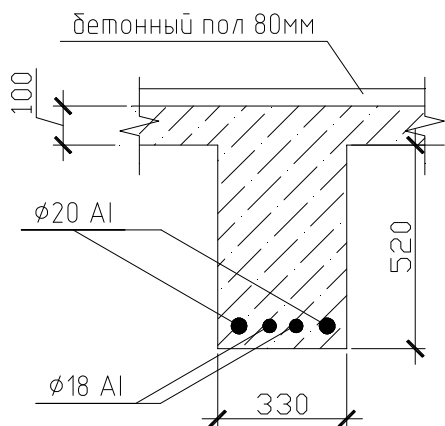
Главная балка ж/б перекрытия фойе над вторым этажом в осях «1-7/А-Г»
